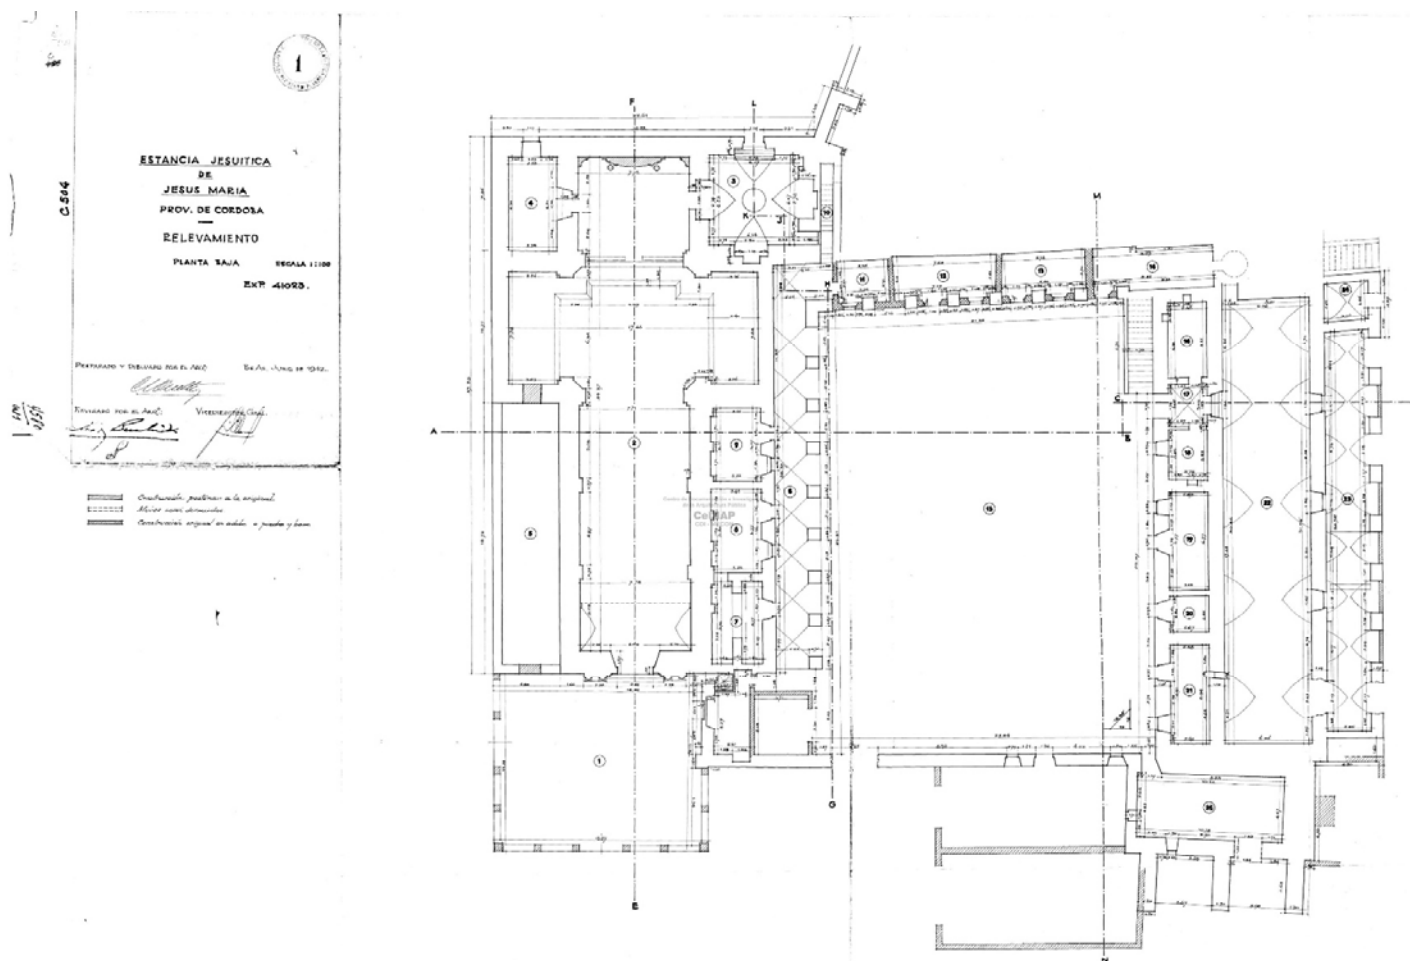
Planta Baja Estancia de Jesús María, relevamiento del Arq. Carlos Onetto. CEDIAP
